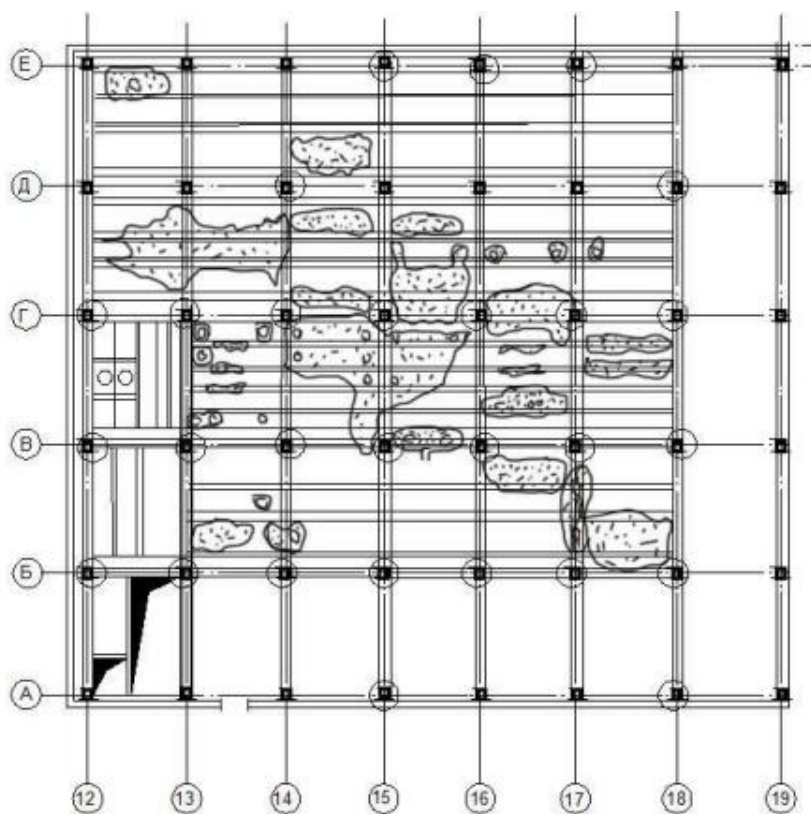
Схема коррозионных повреждений перекрытия первого этажа отделения очистки рассола
